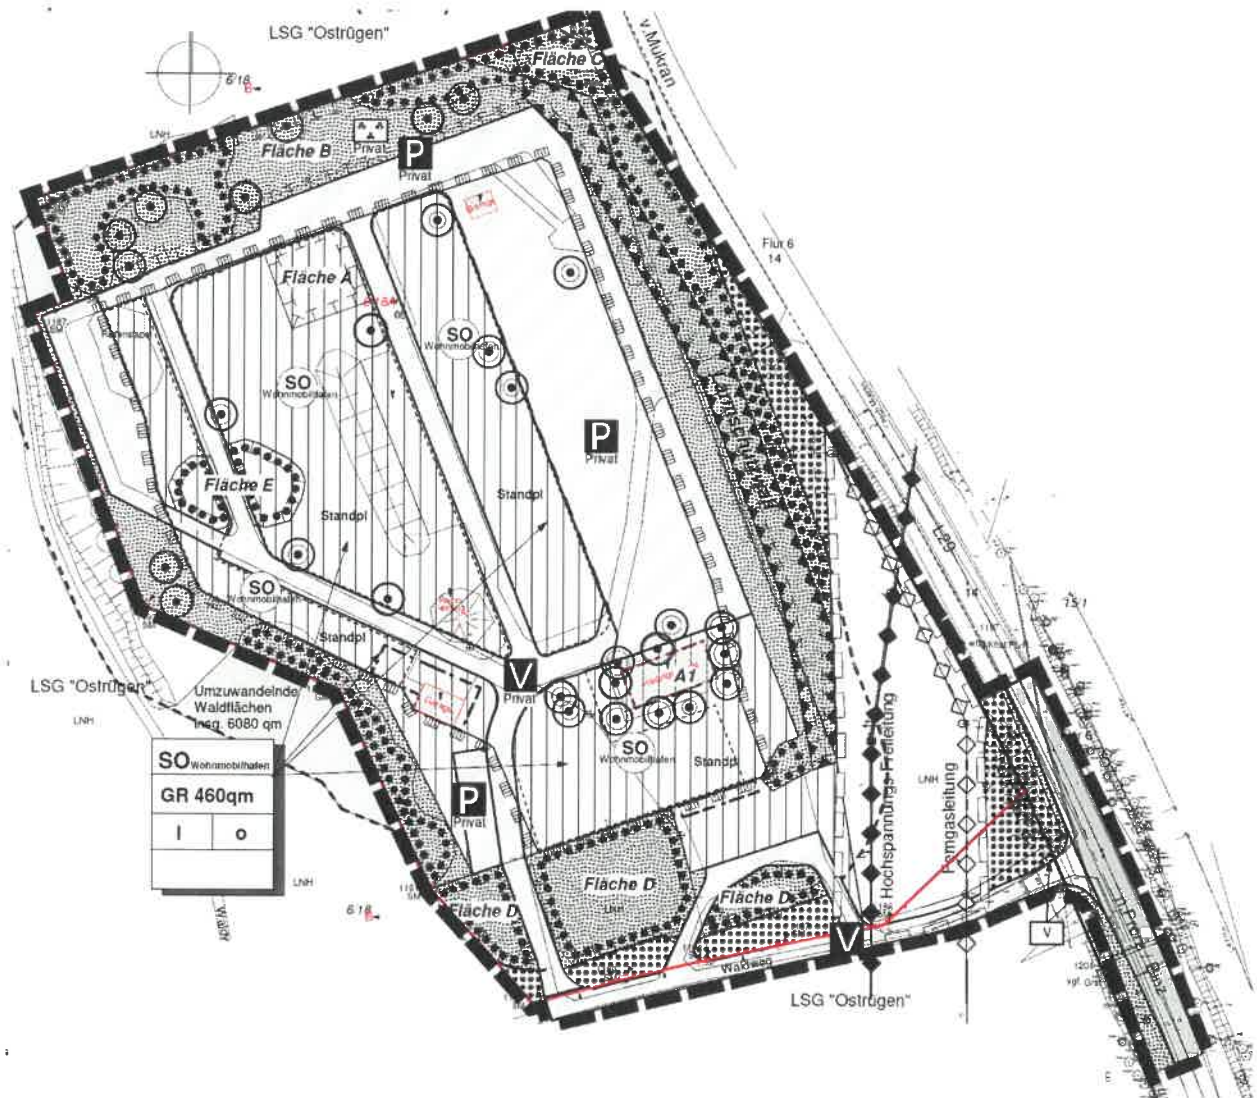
Planzeichnung Ursprungsplan ohne Maßstab
